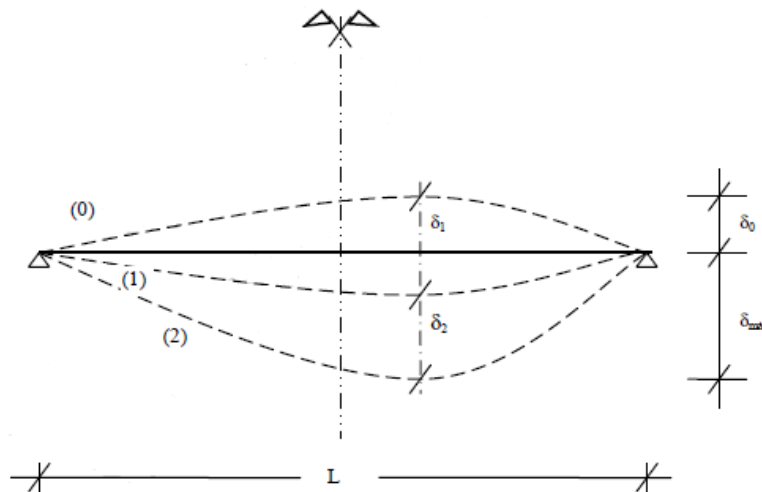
Deslocamentos Verticais - Viga Simplesmente Apoiada
